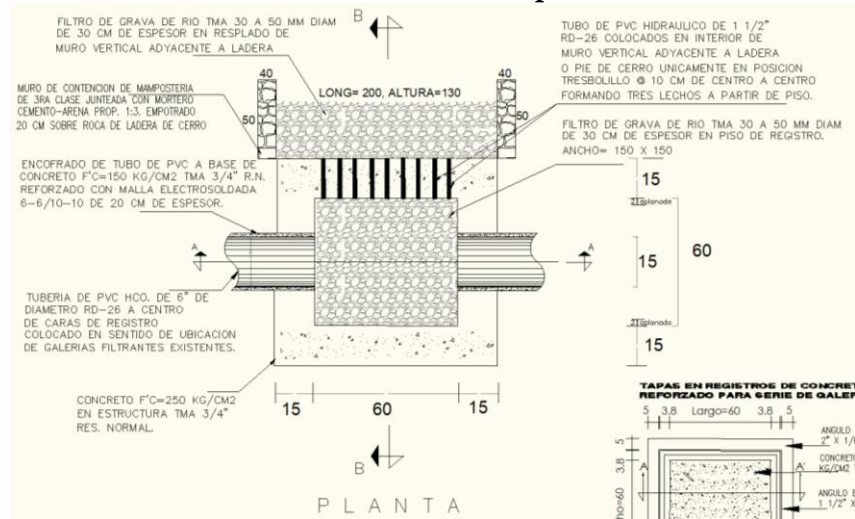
Detalle de interconexión entre los registros de las galerías de las obras de captación.
